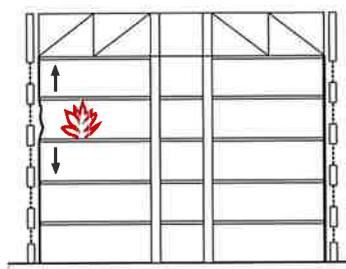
Structure porteuse redondante: Les poteaux de façades sans protection et élançés sont exécutés de manière à être résistants à la compression et à la traction. Si les poteaux d'un étage viennent à défaillir en cas d'incendie, les poteaux situés en dessous et en dessus prennent en charge les forces [17].
